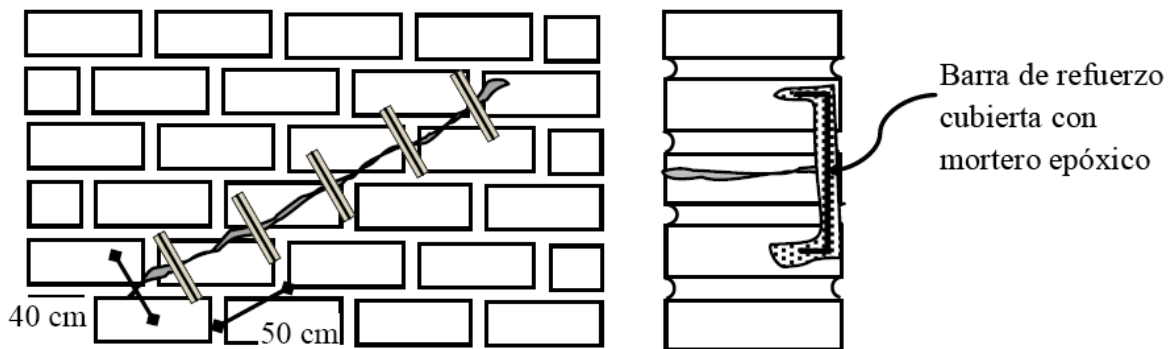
Colocación de grapas sobre grietas (Fuente: Sánchez y Navarro, 2011)
